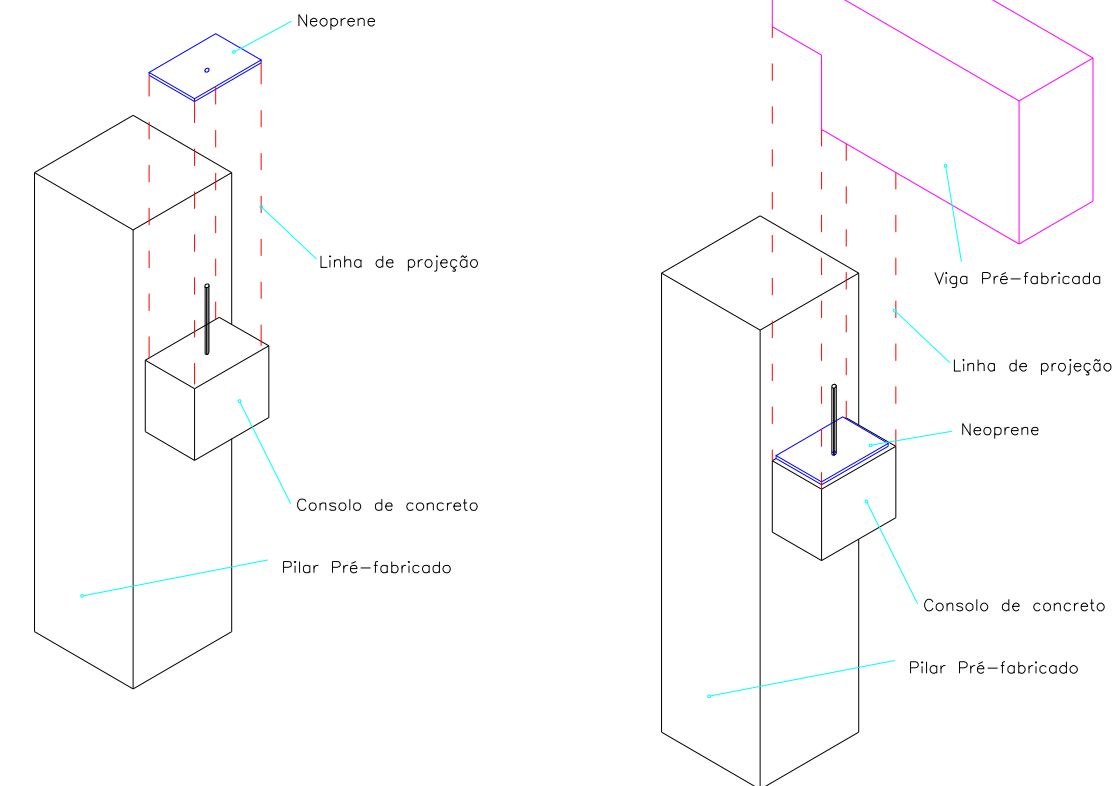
Detalhe do consolo e chumbador em um pilar pré-fabricado.
